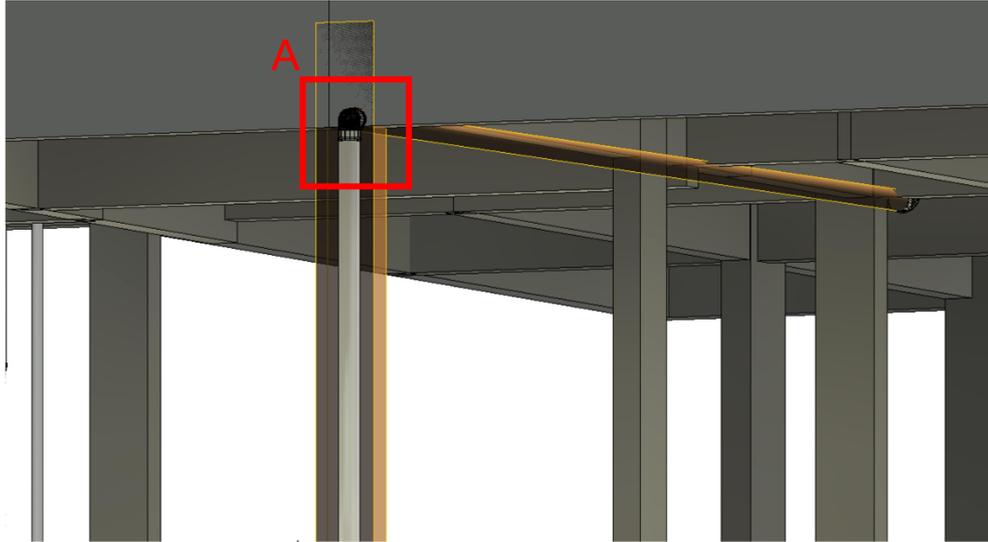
Planta baixa pavimento coberto Hidrossanitário com estrutural
